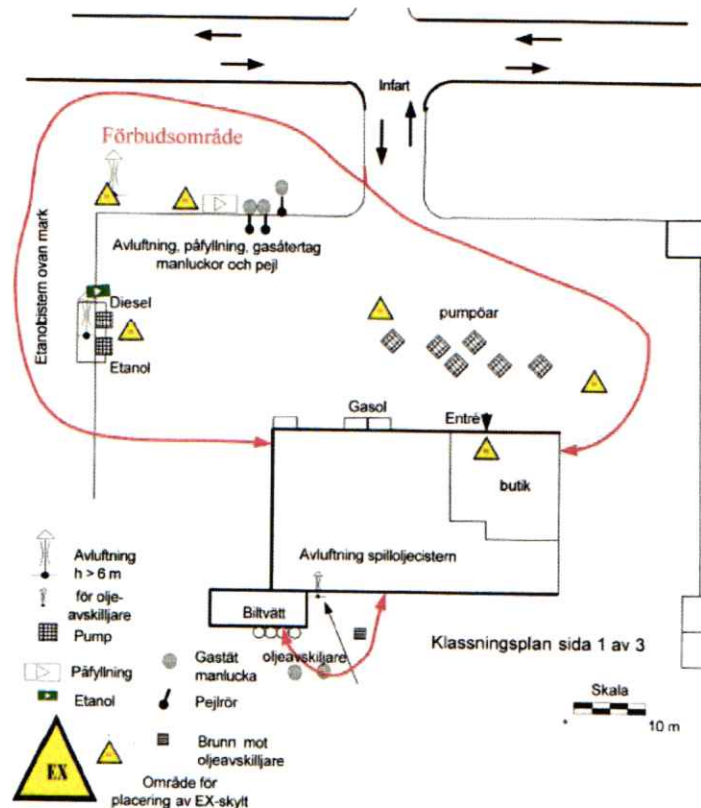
Klassningsplan och situationsplan över OK/Q8-stationen på Mineralvägen (9)
